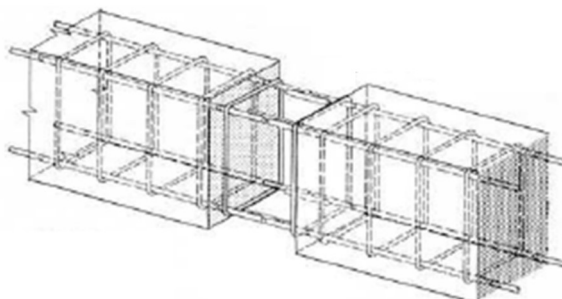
Ligação por betonagem *in situ* (Stupré, 1981)
